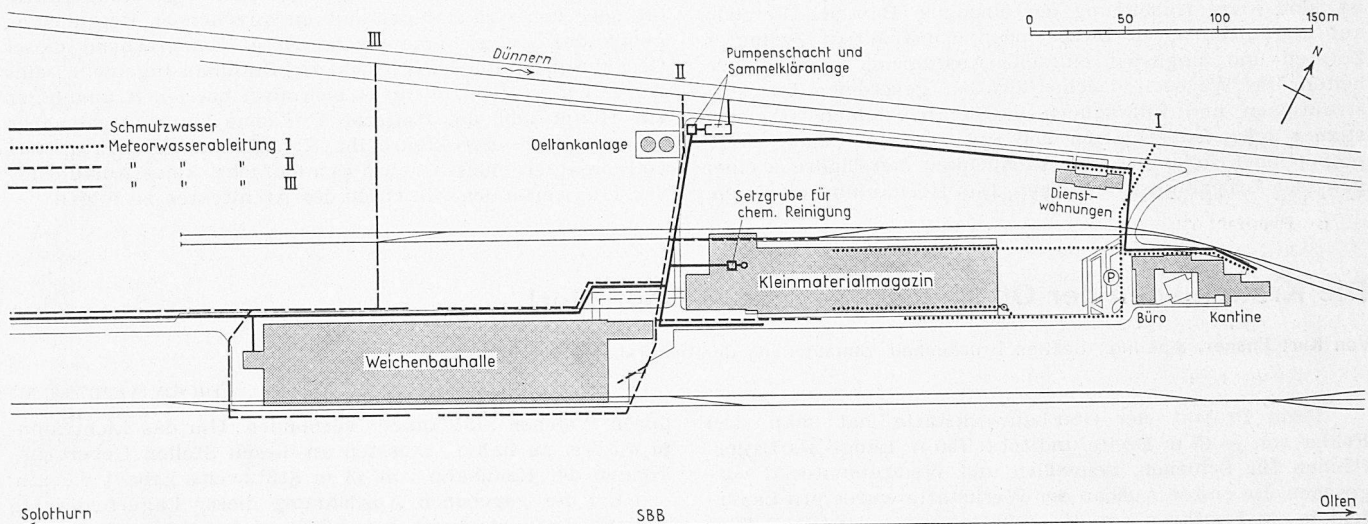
Schema des Kanalisationssystems (Lageplan 1:4000)
